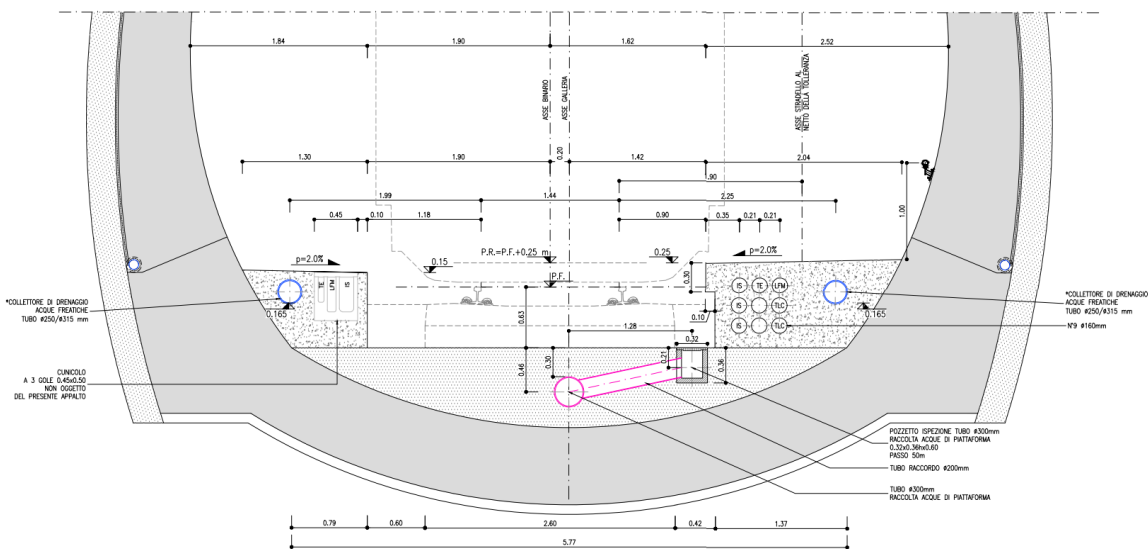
Sezione pozzetti acque di piattaforma - Scavo tradizionale
